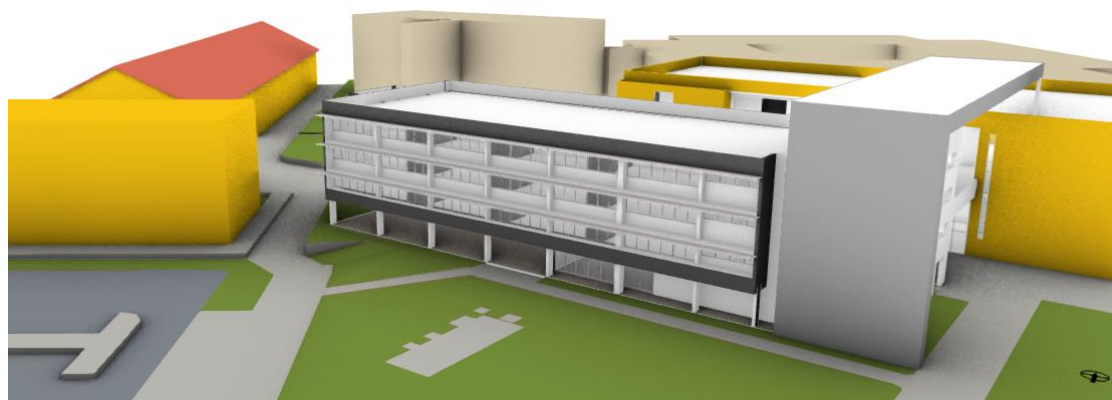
Perspectiva do modelo 3D com vista da fachada norte
